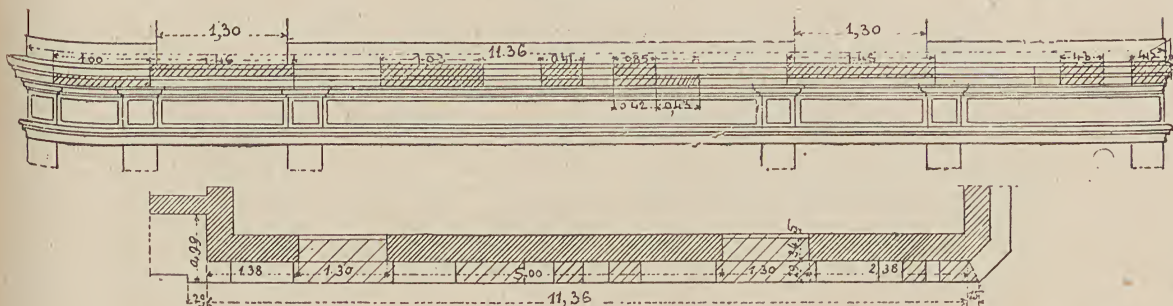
et 108. — Elévation et plan du balcon du 3^e étage. — Restauration en ciment métallique et silicate deux couches, ton gris.
